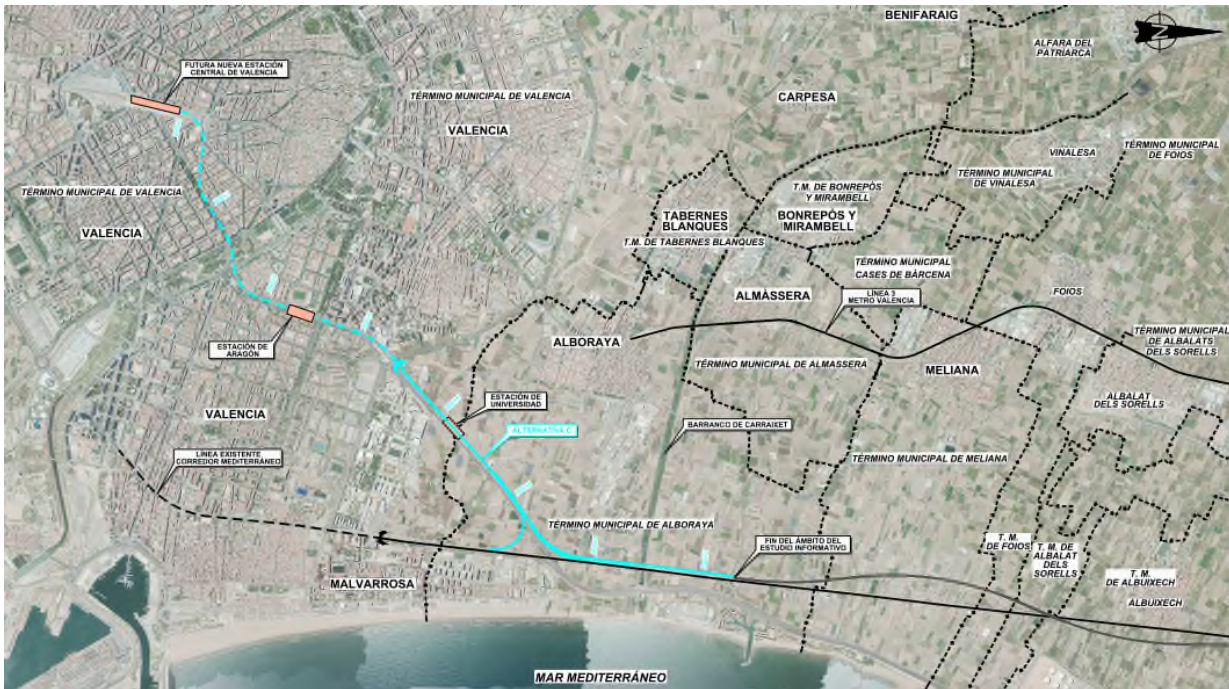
Alternativa C. Fuente: Proyectos Constructivos Previos.
